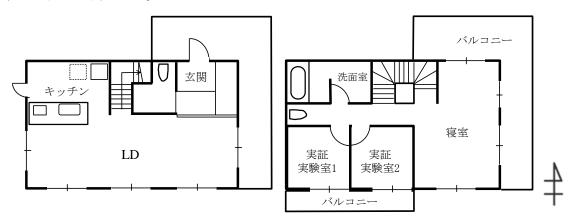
I-1 モデル住宅の平面図(左:1階 右:2階)
